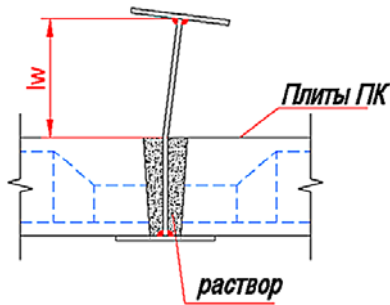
Свободная высота балки при опирании плит по нижним (растянутым поясам балок)
